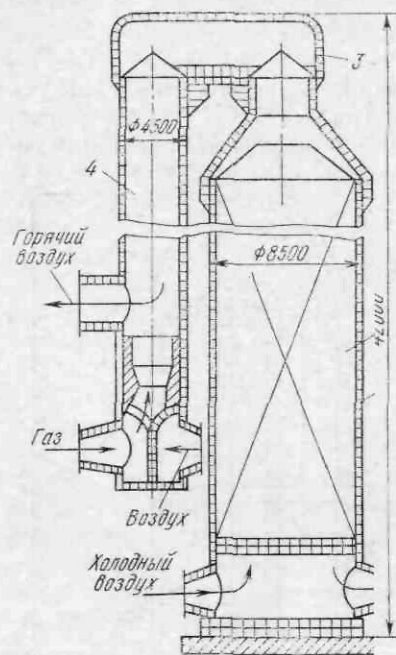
Воздухонагреватель с собственной камерой горения:
